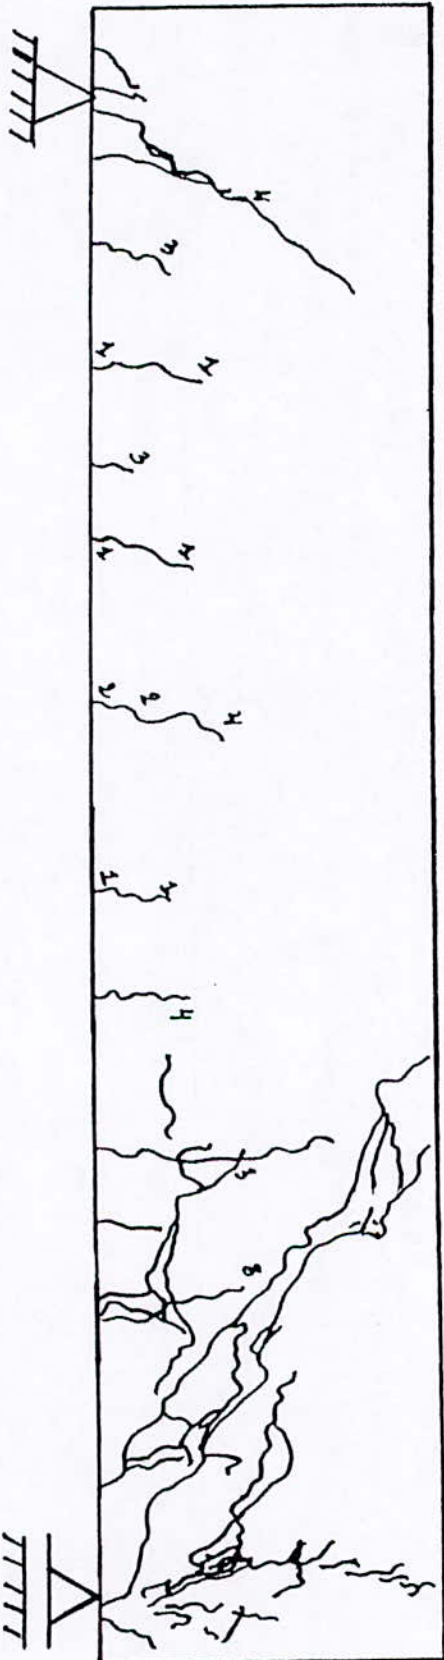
Schéma de fissuration de la poutre T3C
